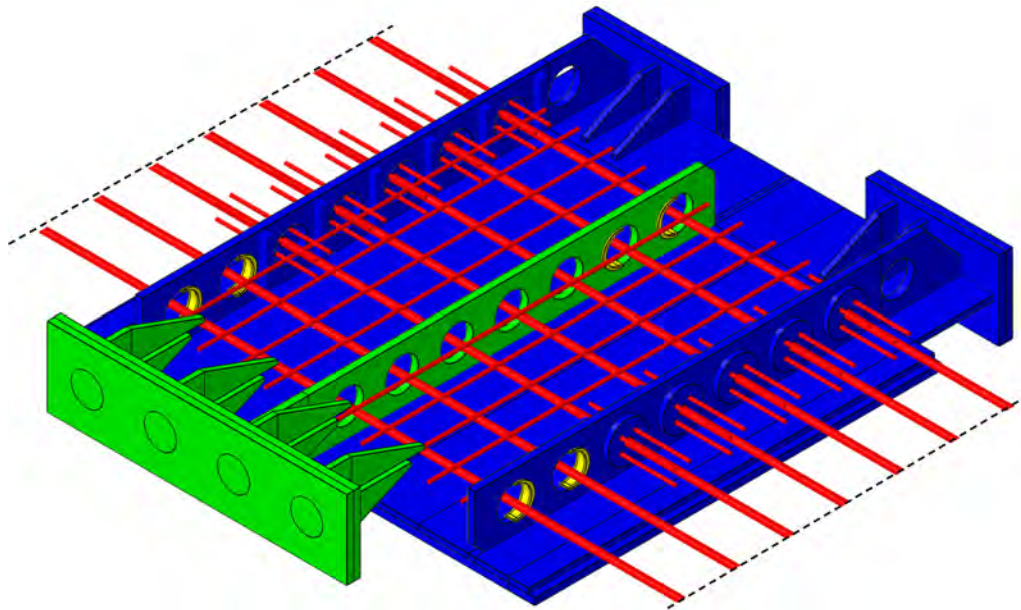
Versuchskörper VK1/3, mit Zug, mit Längs- und Querbewehrung (Mattenbewehrung)
